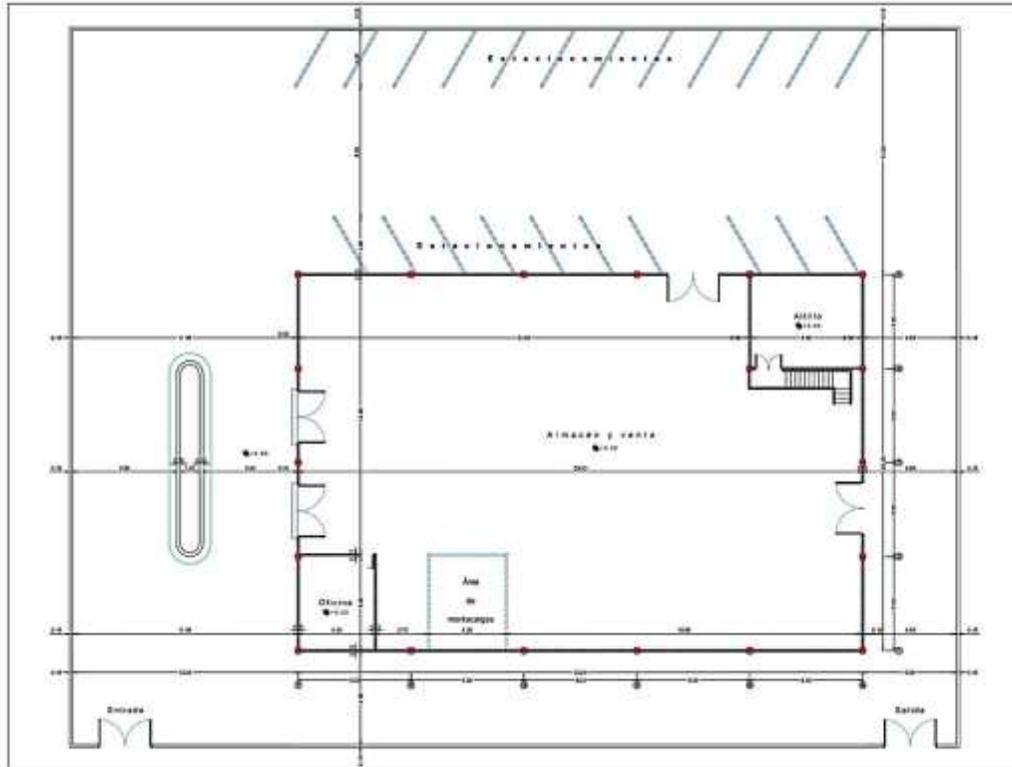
plano distribución de planta (Elaboración propia, 2022).
